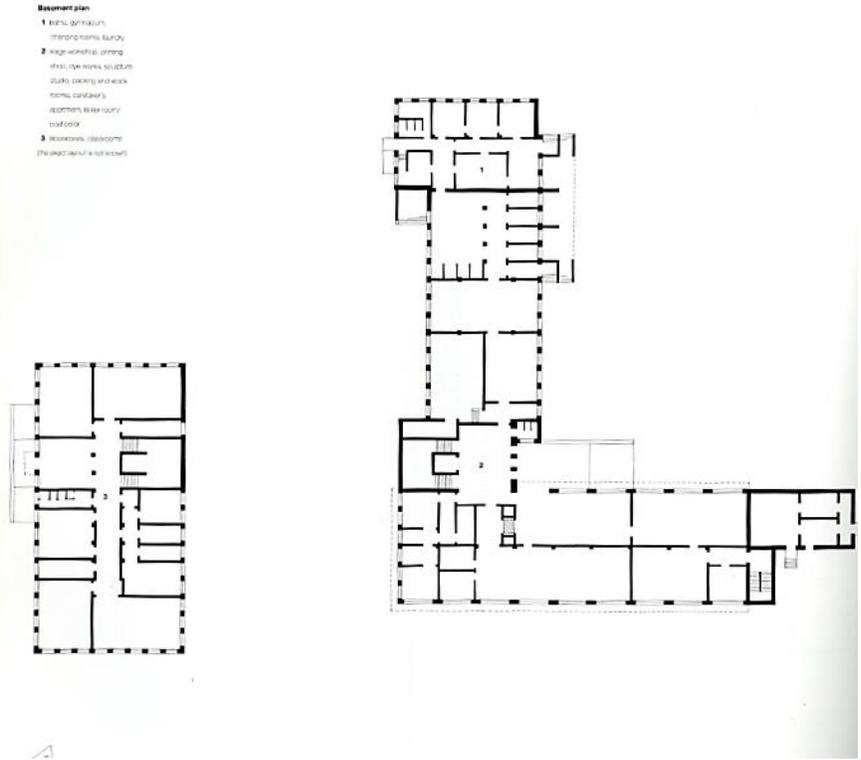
, Planta arquitectónica Nivel 1 de la Bauhaus. Plataforma Arquitectura. 2018
